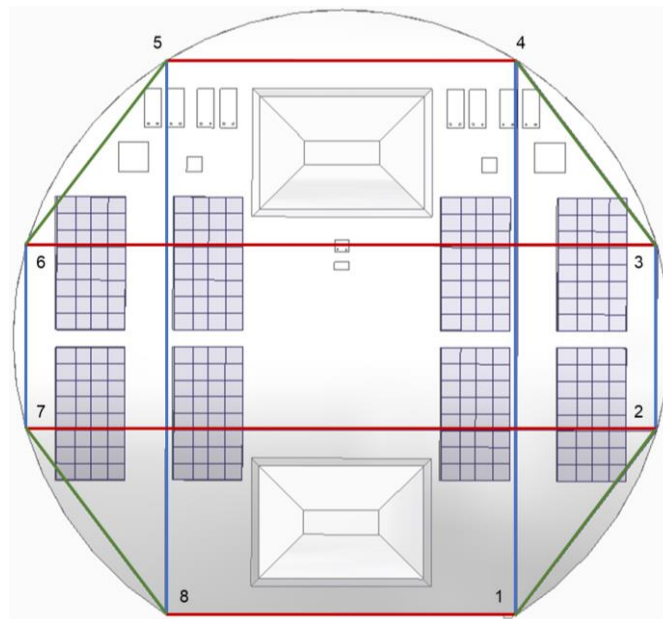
Vista en planta de la distribución de los elementos del techo
